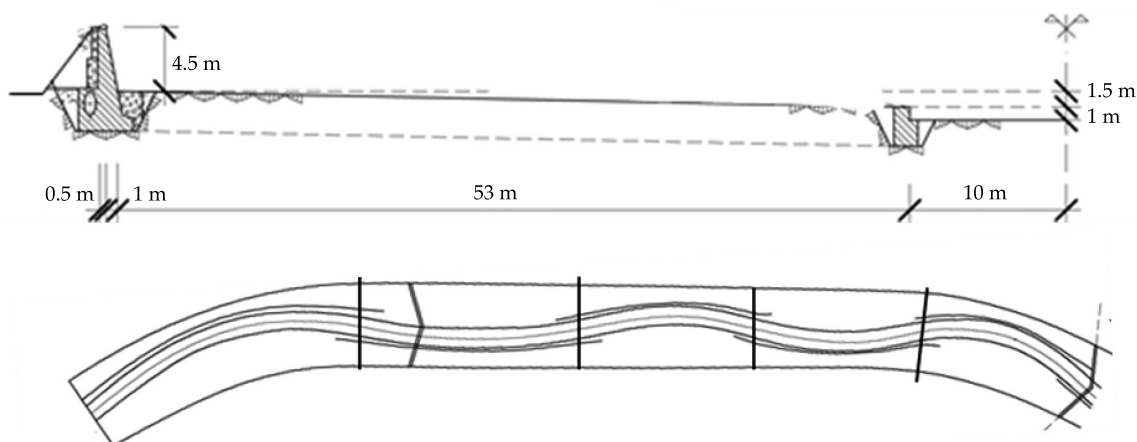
Arriba: media sección transversal (simétrica) de la canalización del río Besòs, objeto de la restauración. Abajo: planta de un tramo del cauce del río Besòs restaurado. Se dibujan los muros del cauce de avenidas (anchura de 130 m), el cauce principal sinuoso (30 m), su eje, las protecciones enterradas en los lados exteriores de las curvas, las traviesas de hormigón por demoler (forma de V) y las nuevas traviesas enterradas (rectas). Flujo de derecha a izquierda.
